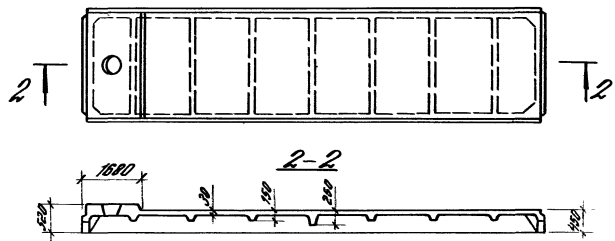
Плита типоразмера 1П12 с проемом в полке $\varnothing 400, 700$ и 1000 мм для пропуска вентилятора
